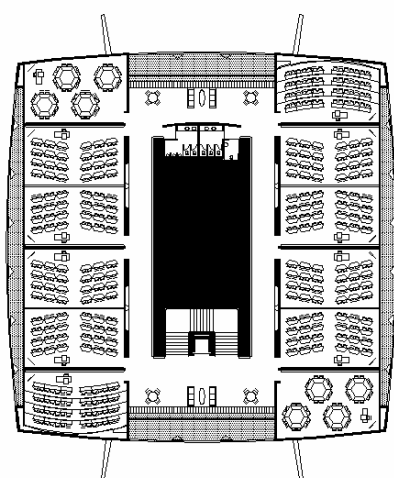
Planta do 1º e 2º pavimentos do edifício da Pós-Graduação Unicnp (fonte: MCA, 2006).
